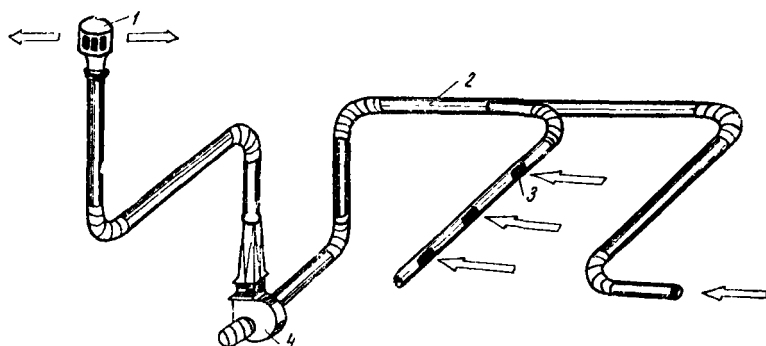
Схема системы вытяжной механической вентиляции с разветвленной сетью воздуховодов:
